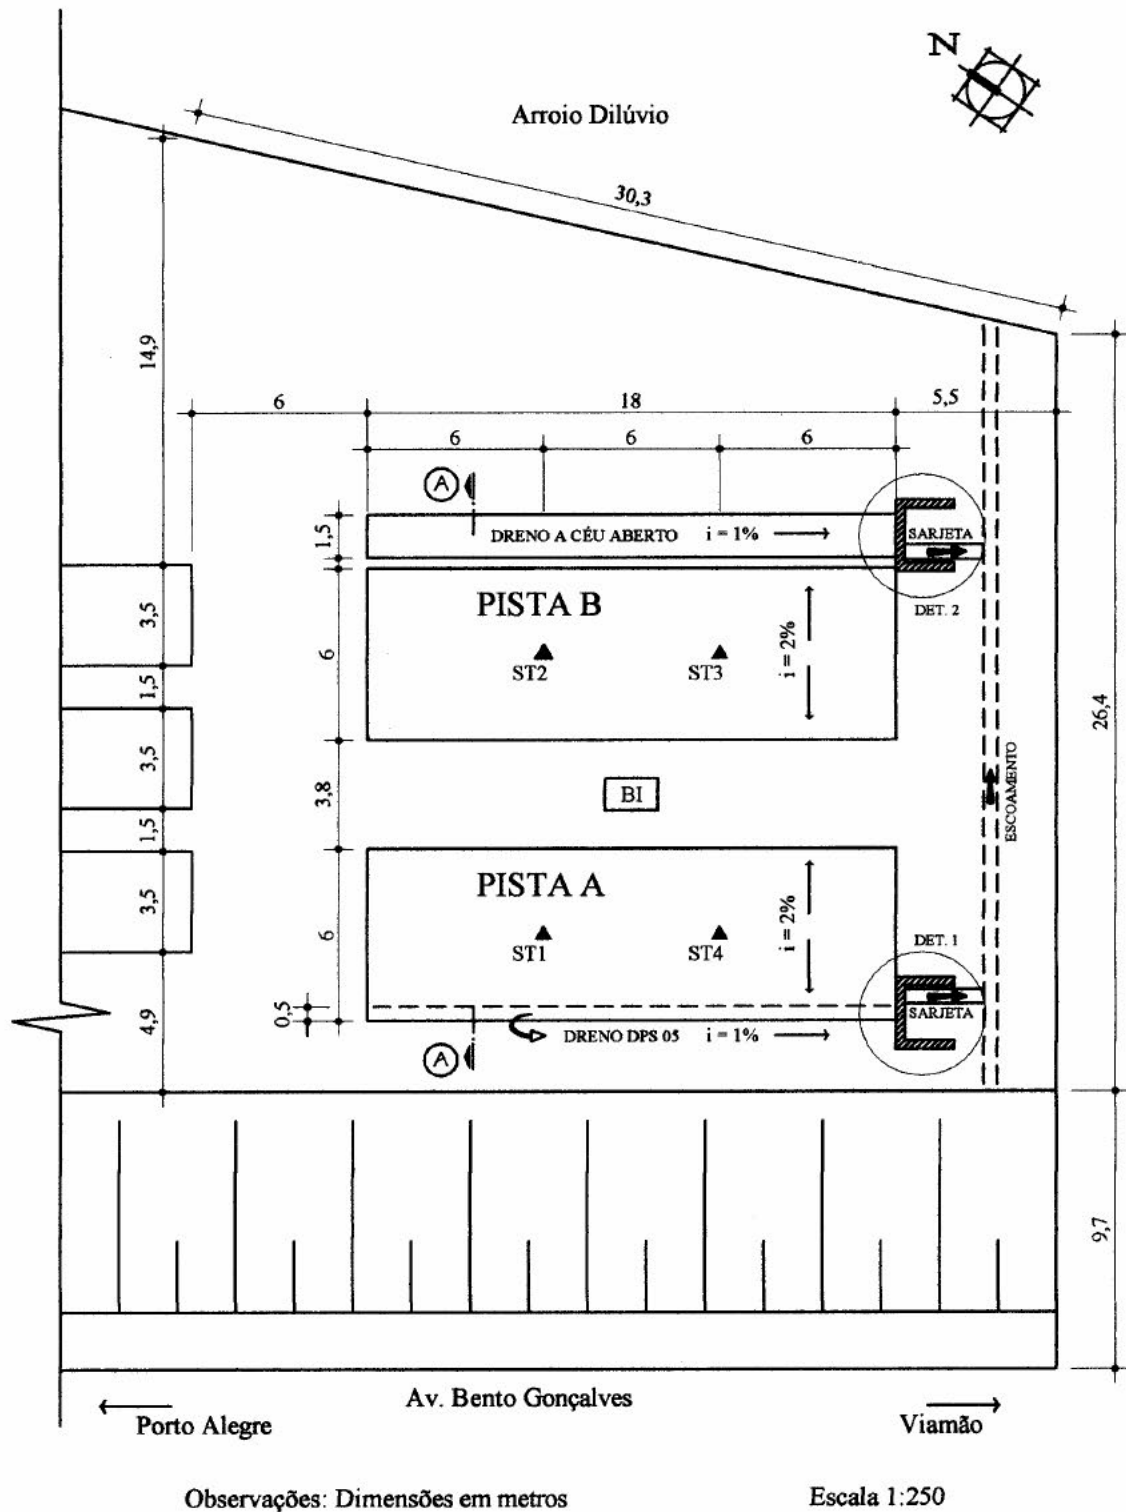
Planta baixa das duas pistas experimentais, Pista A e Pista B, desta pesquisa
